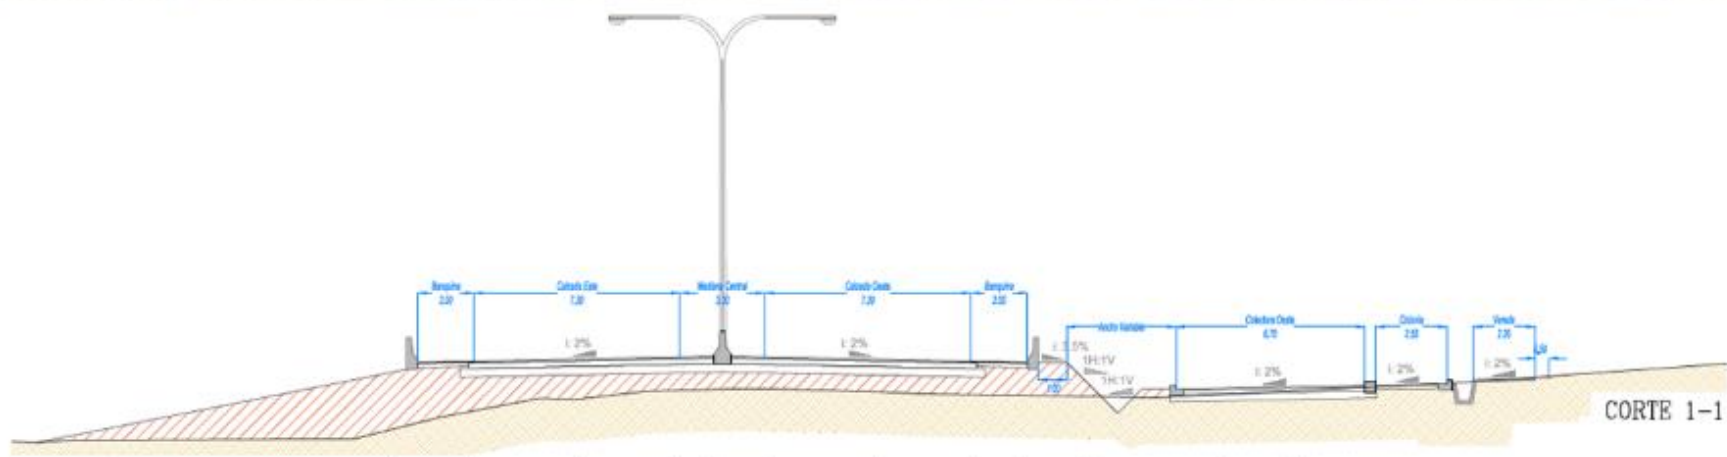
Perfil tipo Tramo Guardia Vieja- Gob. Ortiz, Sector de boliches con calzadas en distinto nivel
